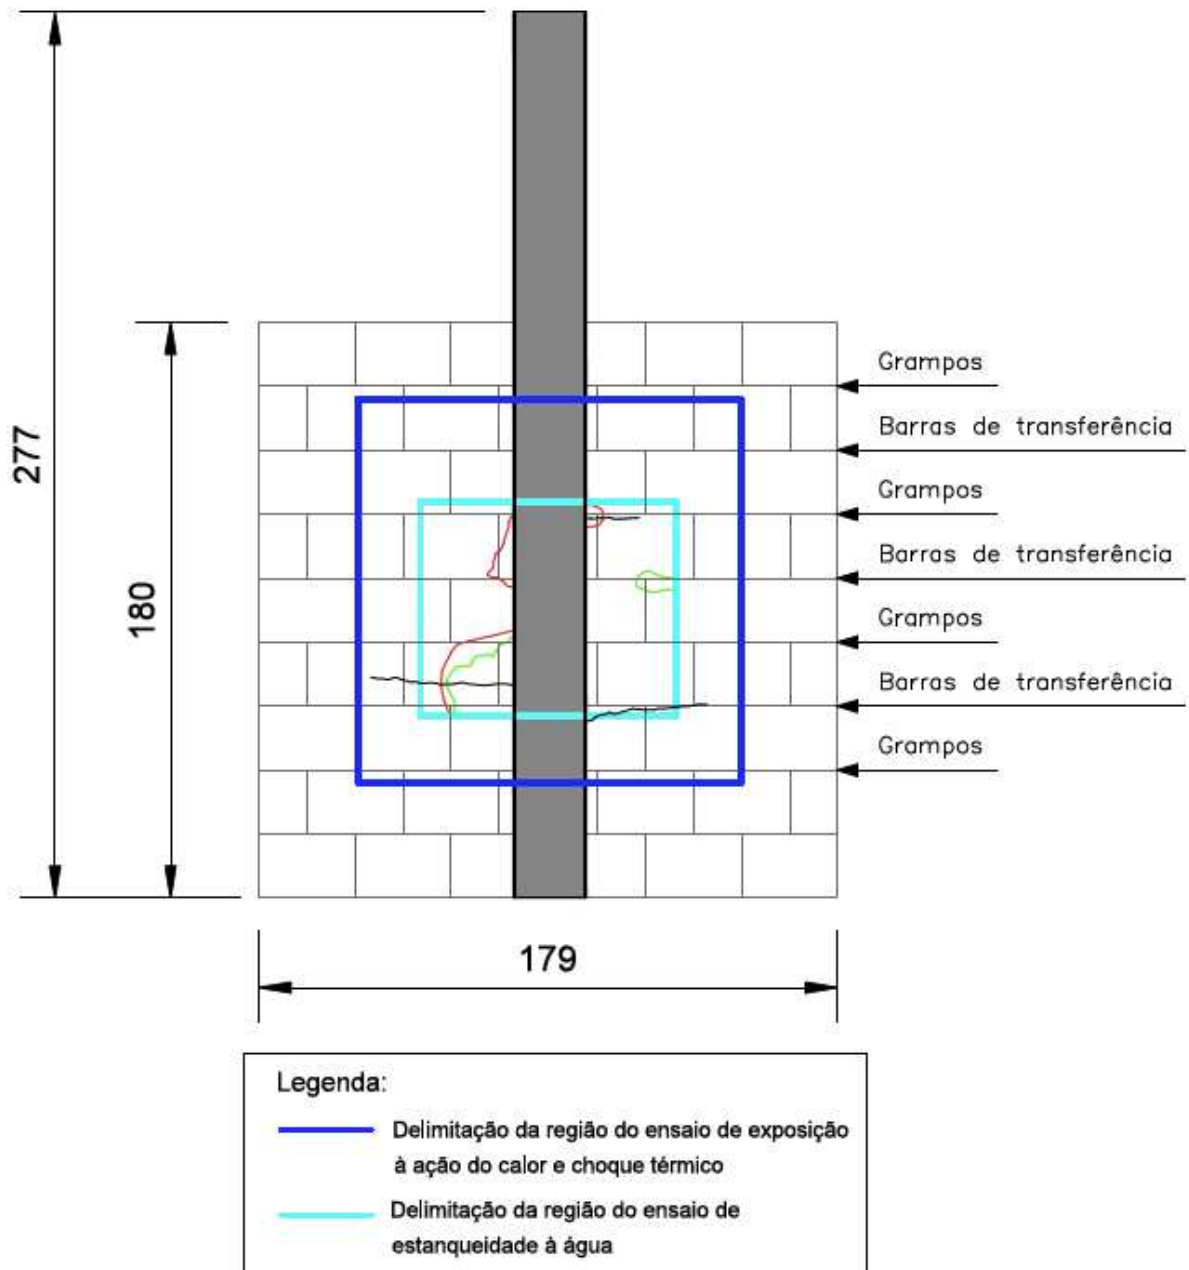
Fissuras horizontais na face interna do modelo PAR-JV-R2.
